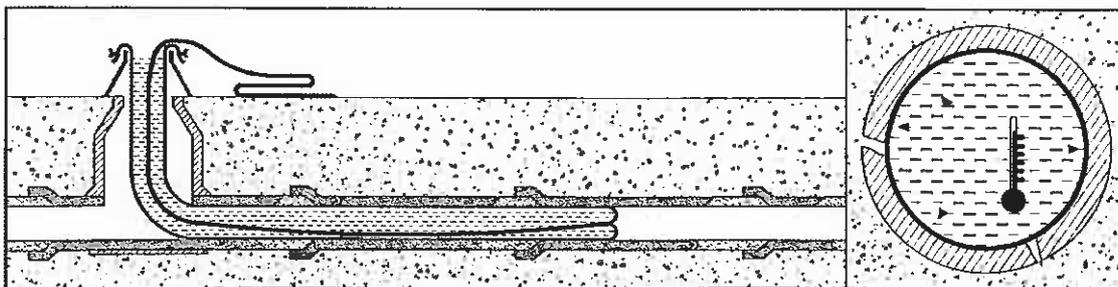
Prinzipskizze Renovierungsverfahren mit Schlauchlining (Quelle: ÖWAV RB28)
